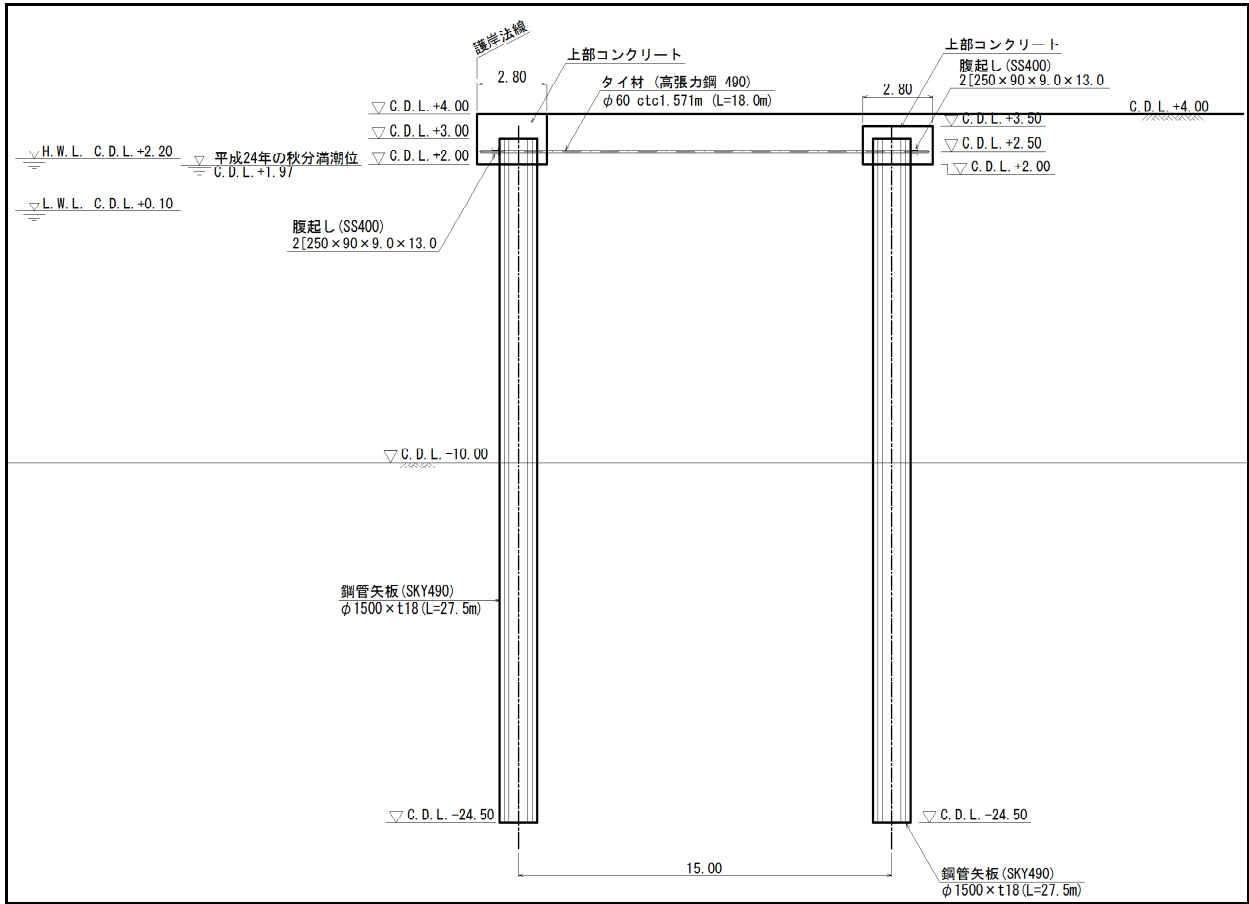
中仕切岸壁 A (-10.0m) 標準断面図
